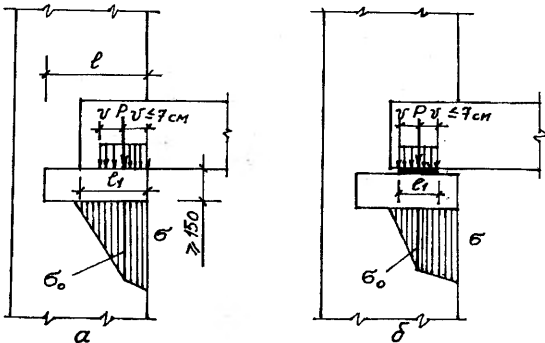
Схема нагрузок и напряжения при расчете опорной плиты: а - опирание балки без фиксирующей прокладки; б - то же с прокладкой
